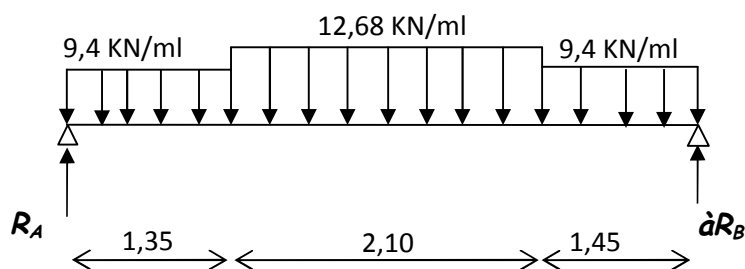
Schéma statique d'une barre à l'ELS
